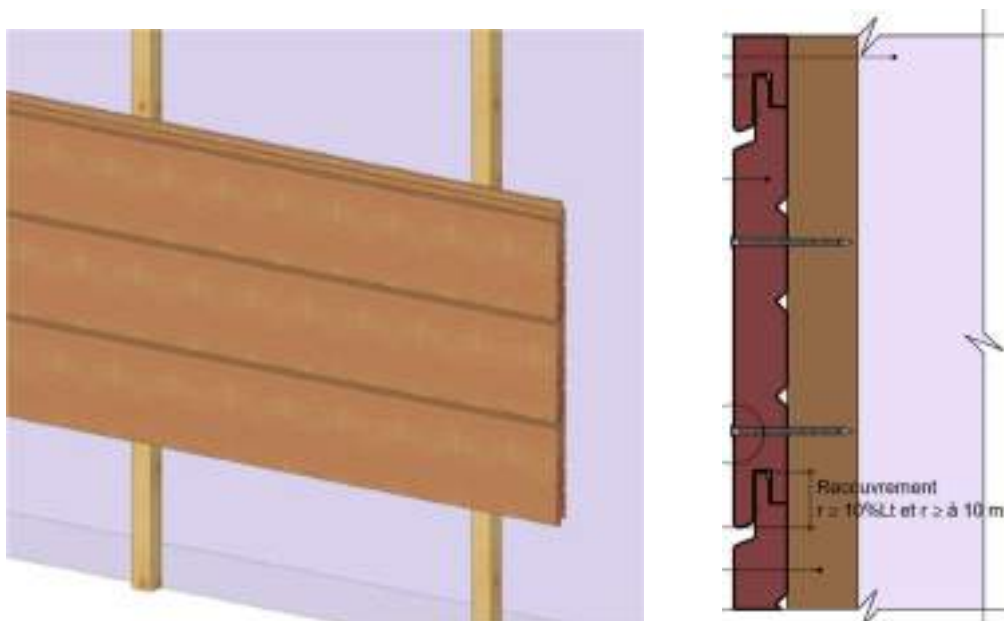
Lames à emboîtement – pose horizontale (illustration 3D et coupe verticale)
